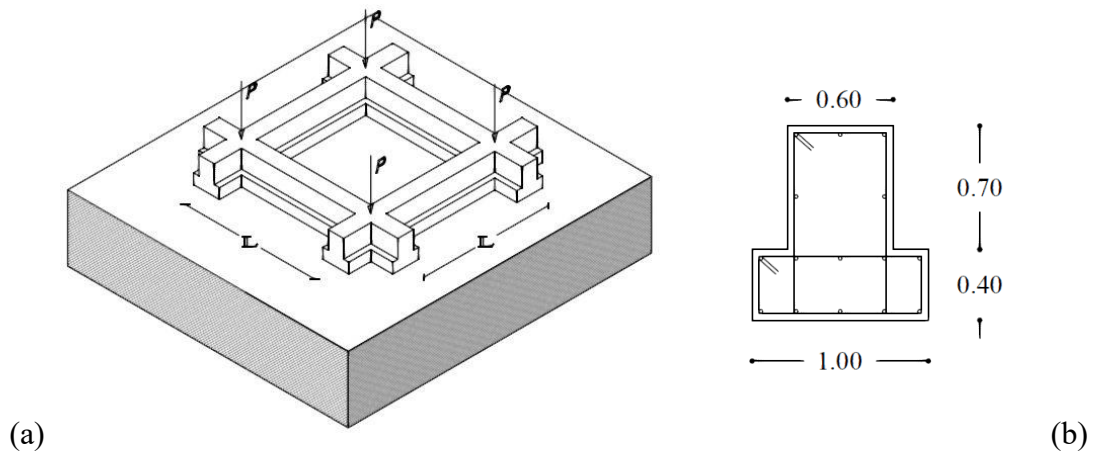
Grigliato di travi di fondazione soggetto a carichi concentrati. Vista tridimensionale (a); dimensioni (in metri) sezione trasversale delle travi (b).
